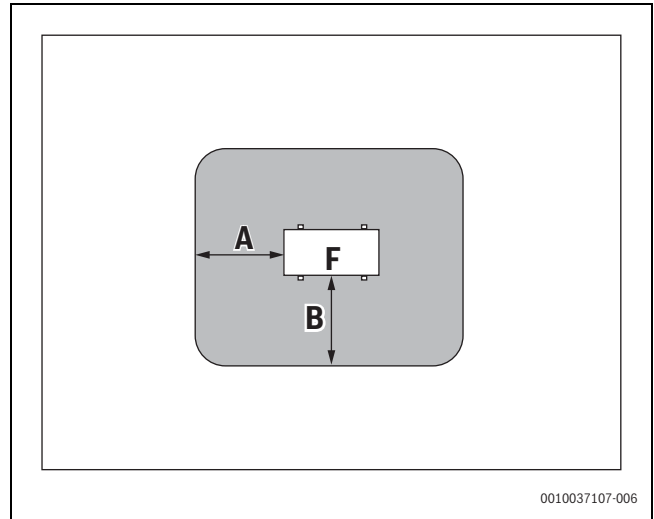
Schutzbereich bei bodenstehender Aufstellung auf dem Grundstück oder Dach
